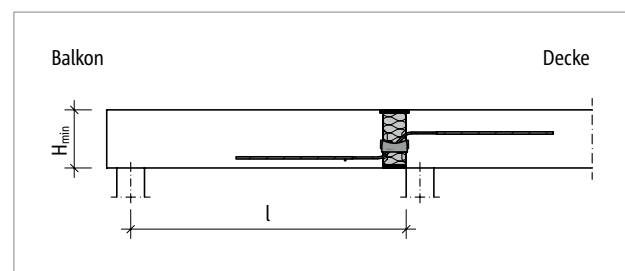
Schöck Isokorb® T Typ QL-V2 bis V6: Statisches System
